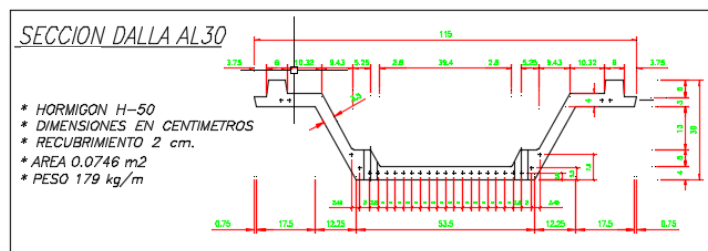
Sección transversal de canalones de hormigón, ejemplo 1.
